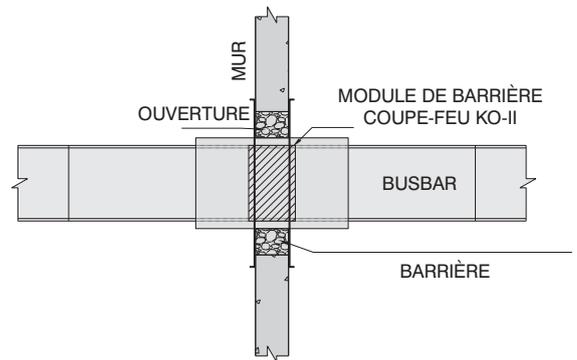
CROISEMENT DU MUR AVEC BARRIÈRE COUPE-FEU
